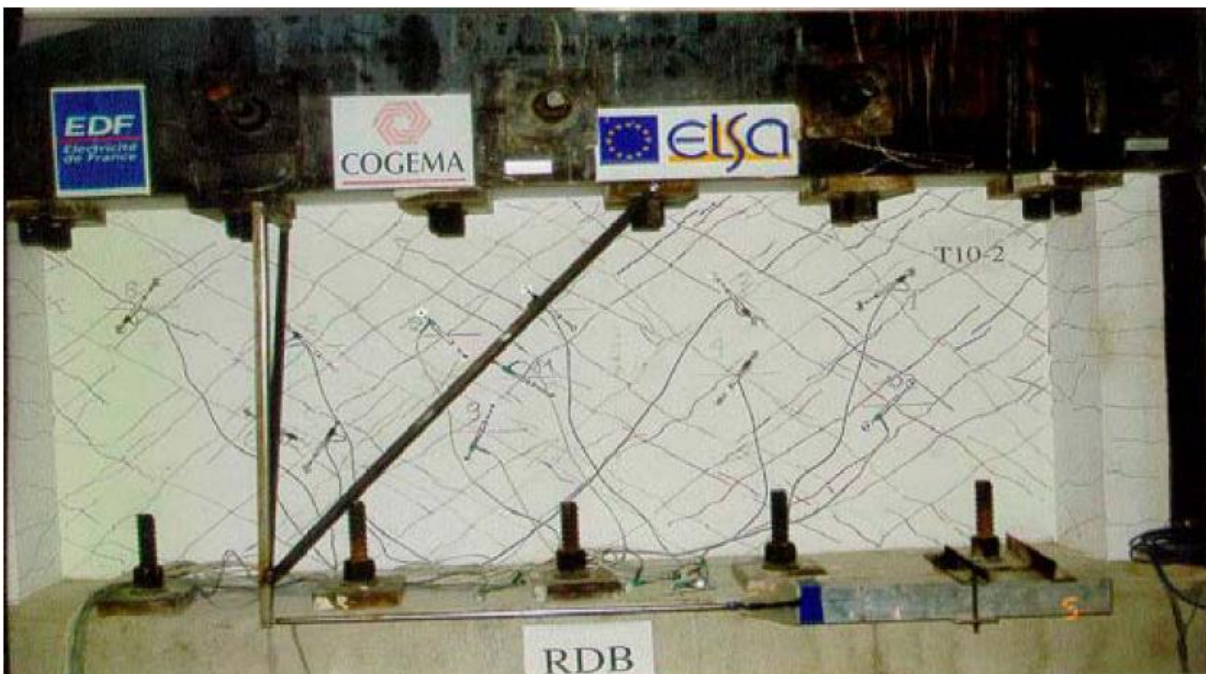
faciès de fissuration en fin de run de la maquette N° 10
